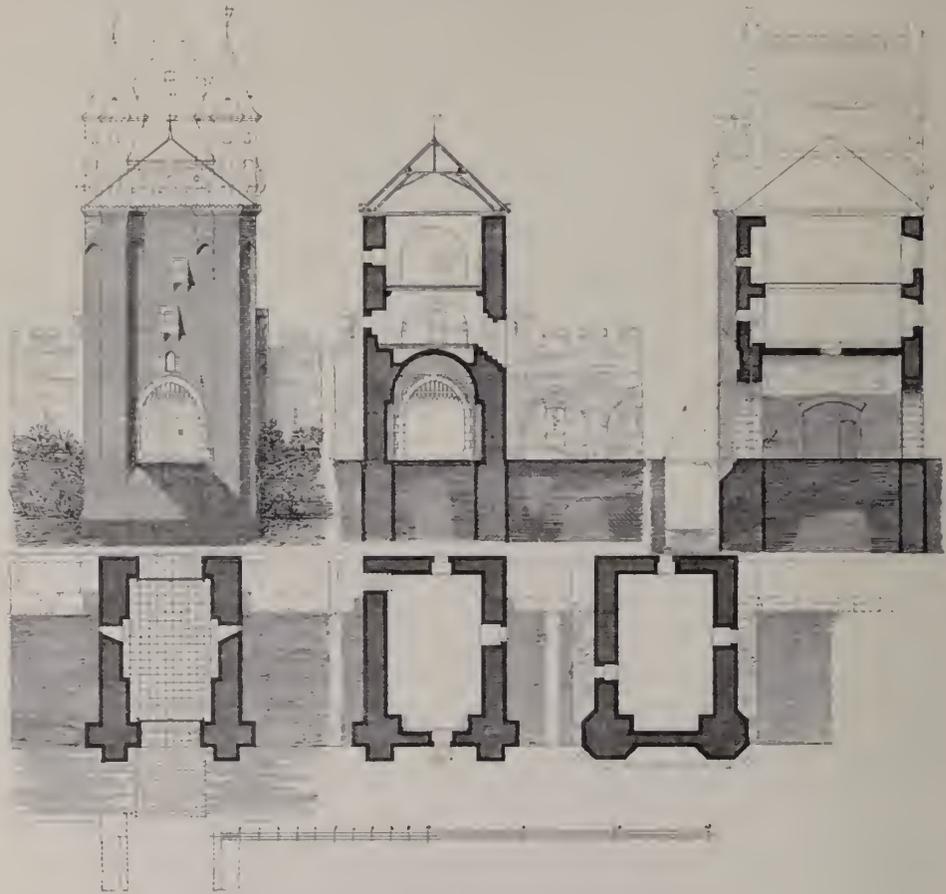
Kempen. Grundriss und Aufriss des Kuhthors.
